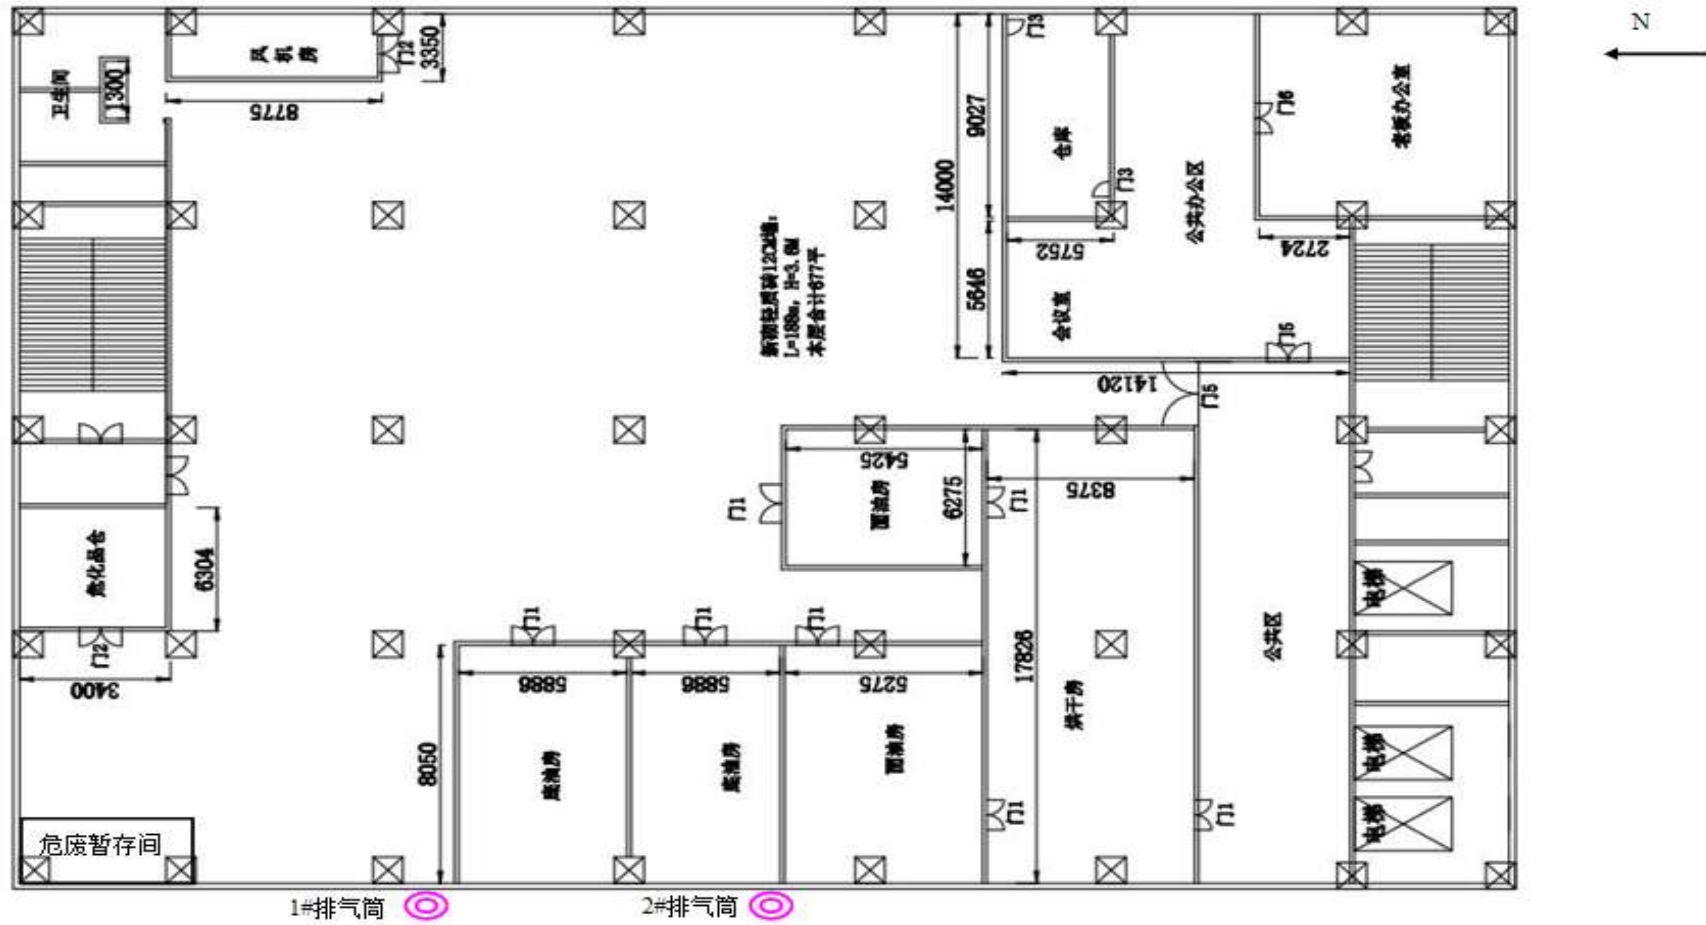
项目 3A 号厂房 9 楼总平面布置图
